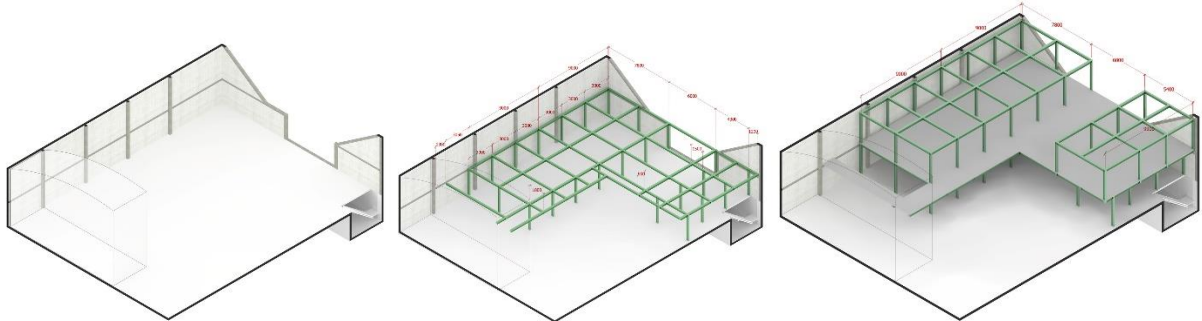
ESCOLA CASA FUNDAMENTAL – USO DA ESTRUTURA DO GALPÃO JÁ EXISTENTE
